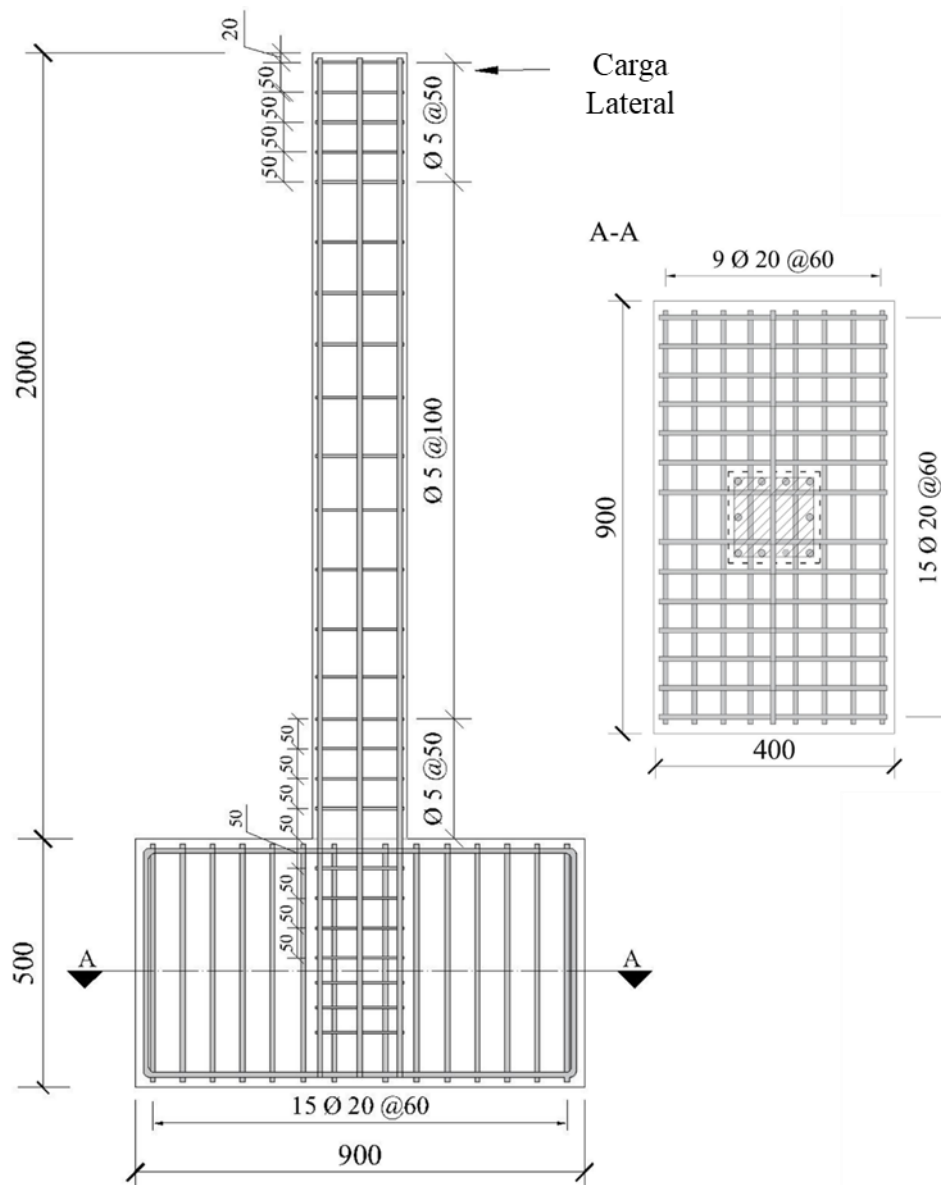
Detalhe das armaduras dos pilares modelados no ABAQUS/CAE
